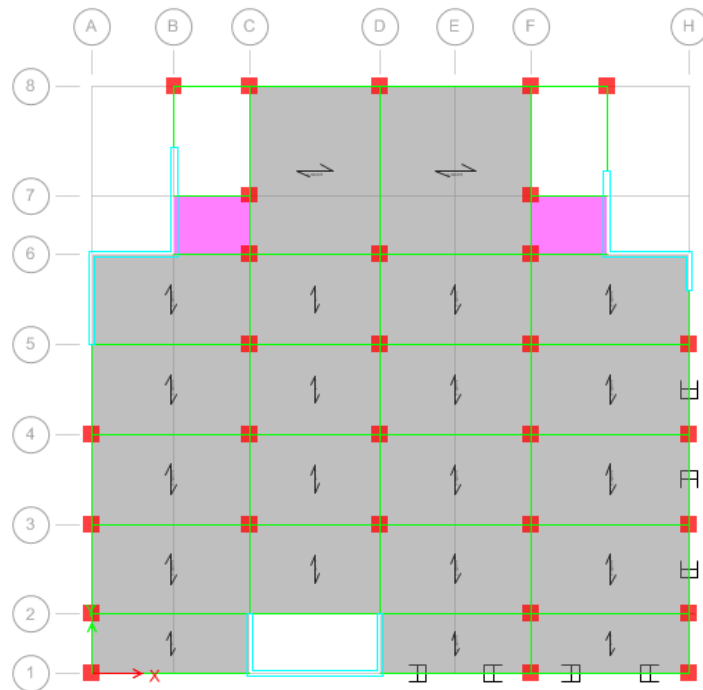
Vista en planta, primer caso de ubicación de dispositivos
